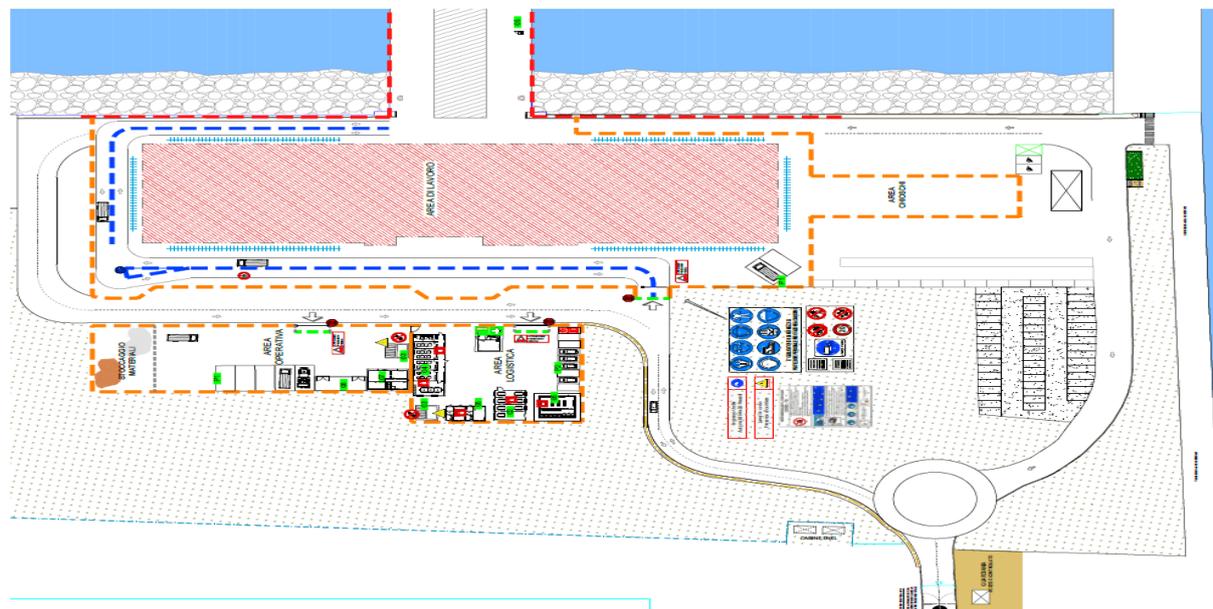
RAV PE-H4-Planimetria e Viabilità di Cantiere Fase 2
